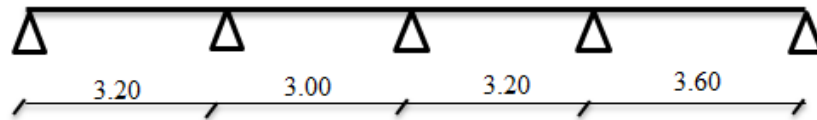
Poutrelle type 01 (Plancher RDC et étages courants)
